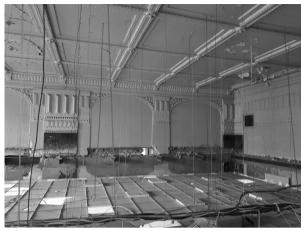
Λ епной декор стен и потолков помещения ресторана Fig. 8. Stucco decoration of the walls and ceilings of the restaurant room
